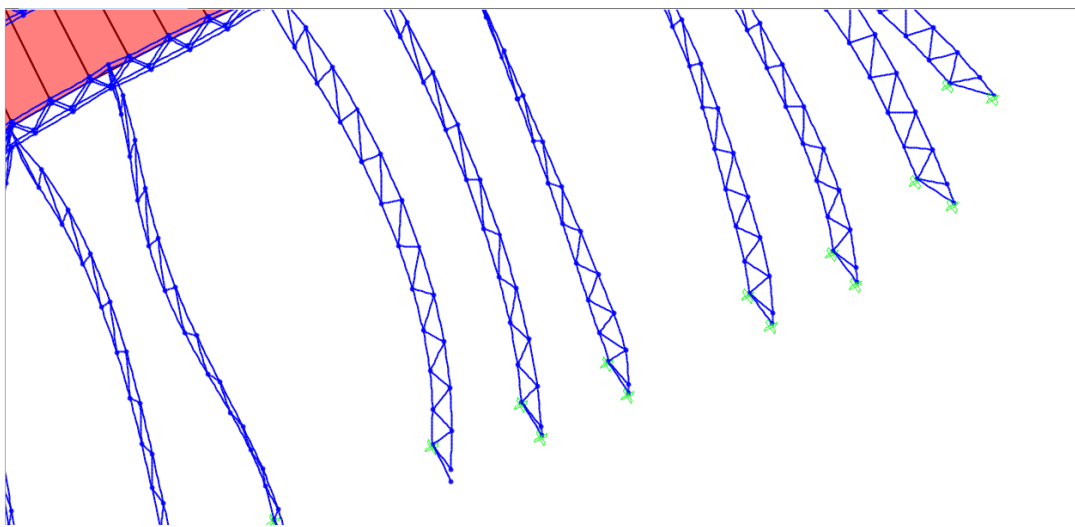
Modelamiento estructural del coliseo Fuente Propia.
